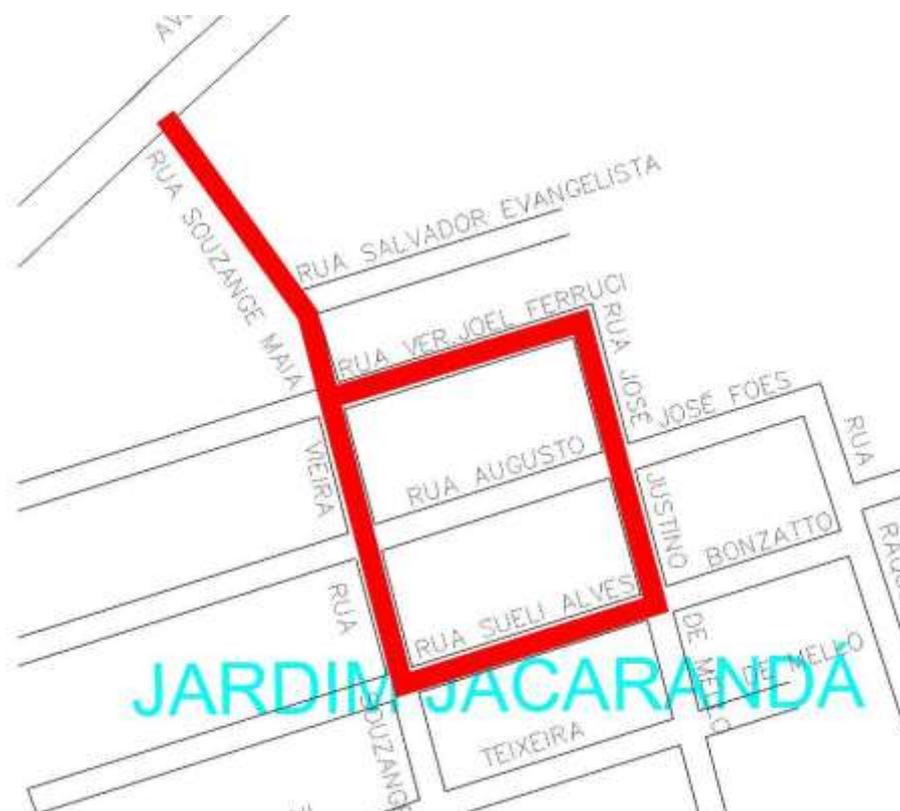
Ruas do Jardim Jacarandá em pavimentação primária (extensão total de 700 metros)
